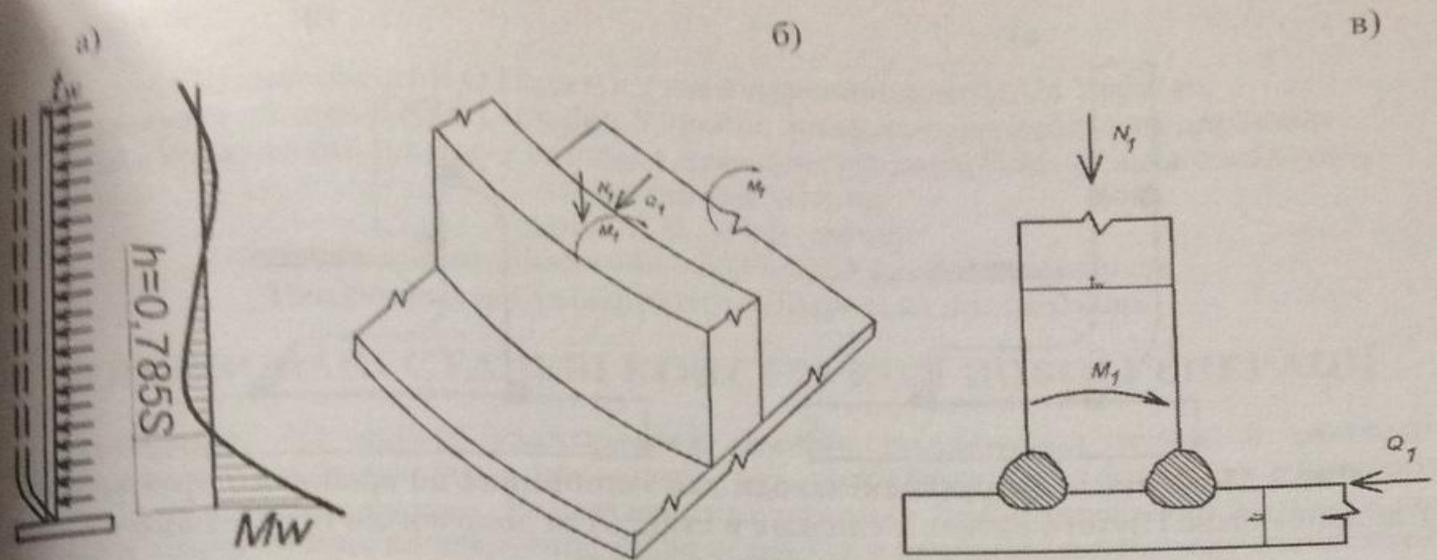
Розрахункові параметри з'єднання стінки резервуару з днищем:
